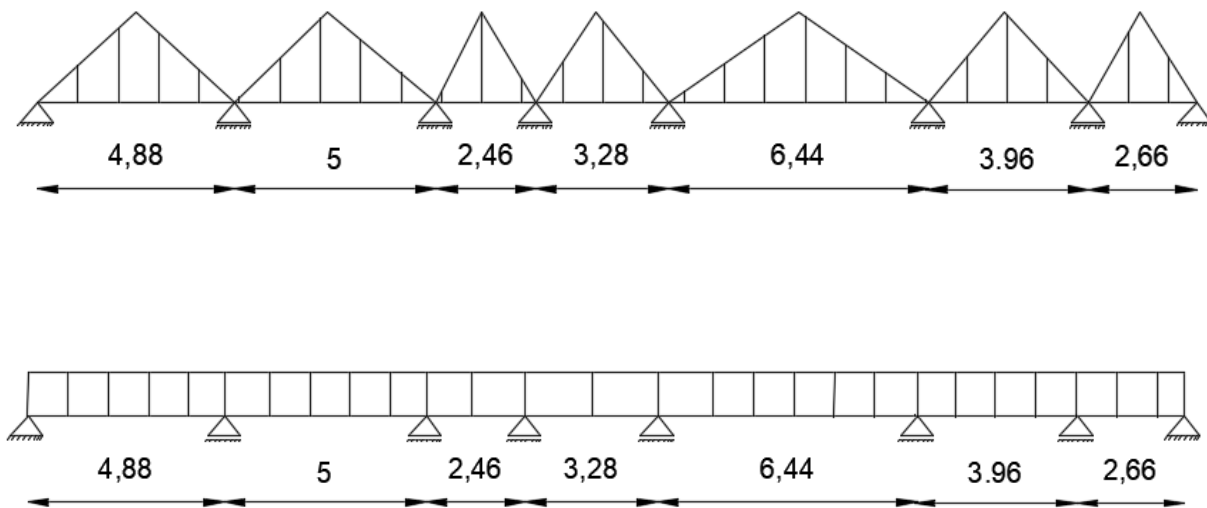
Distribution des charges sur les poutres secondaires.
